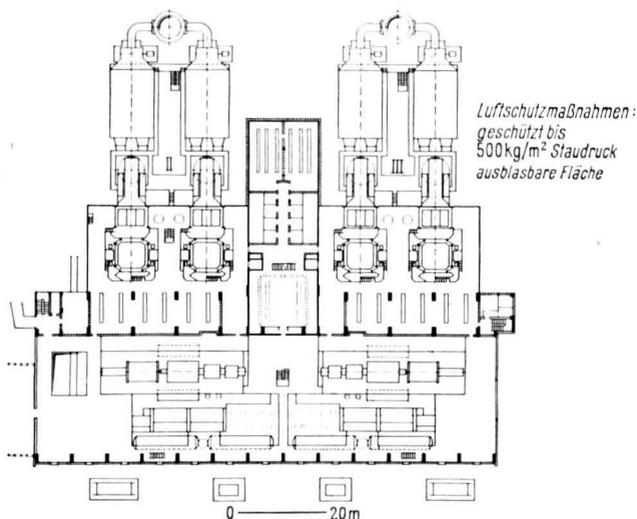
Kraftwerk, Block II und III. - Grundriß + 9,00.
